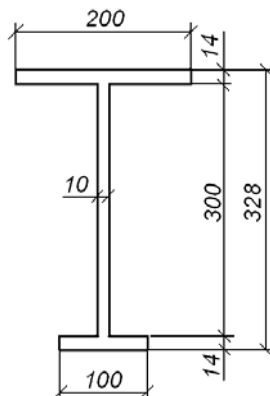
Сечение экспериментальной балки серии БСУ, предварительно напряженной вытяжкой нижнего пояса
